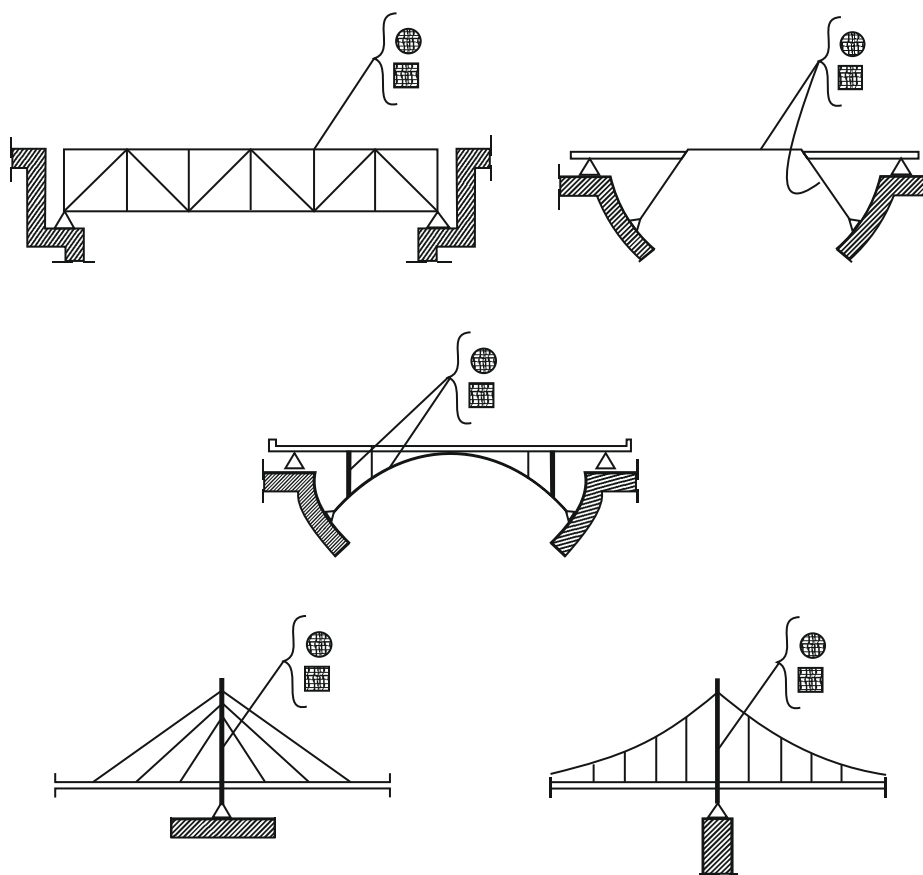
Использование трубобетонных элементов круглого и квадратного сечений в мостах различной формы [9]
